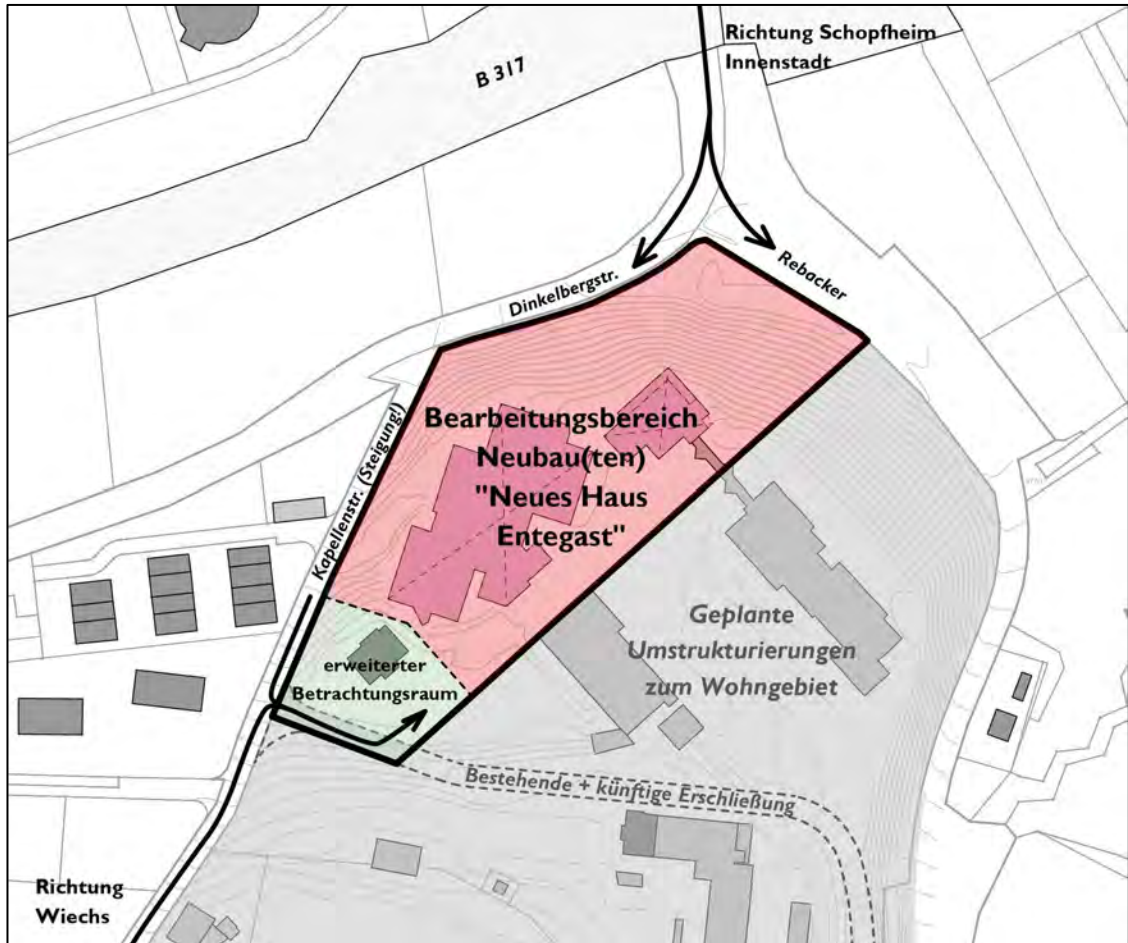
Darstellung des Wettbewerbsbereichs mit Bearbeitungsbereich für den / die Neubau(ten) und erweitertem Betrachtungsraum. Darstellung: Stadtbau Lörrach.
